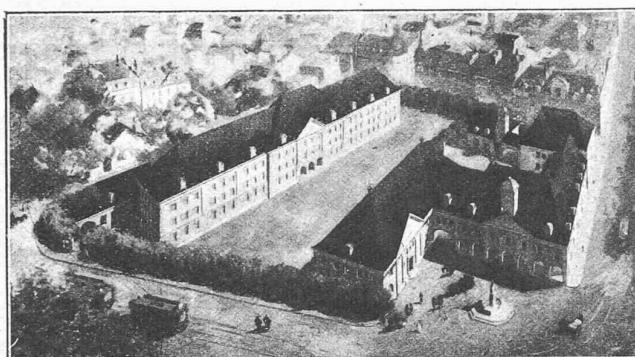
Vue à vol d'oiseau du projet de MM. Senglet, Saager et Frey.
